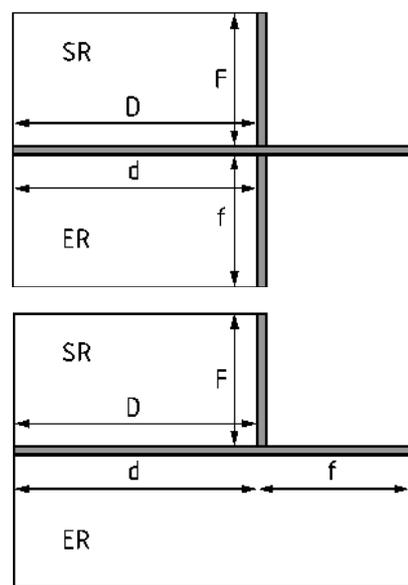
Abgewinkelte trennende und flankierende Bauteile, Grundriss
